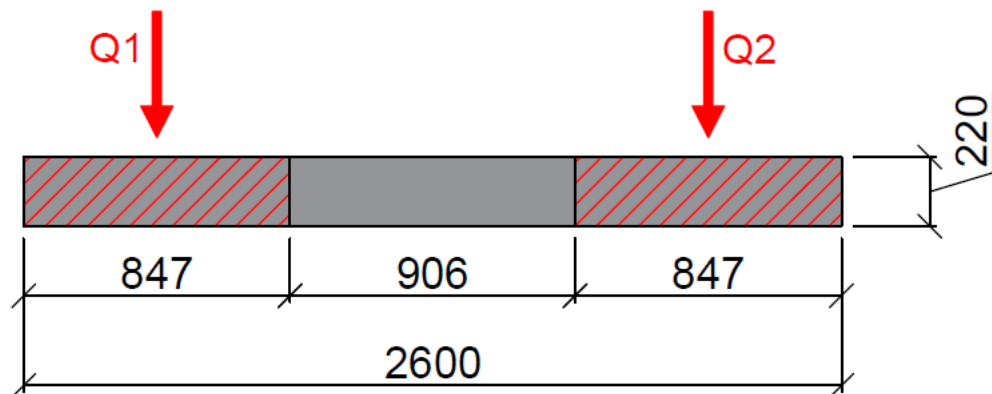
Planta y alzado de la traviesa, se han representado la posición  $t$
